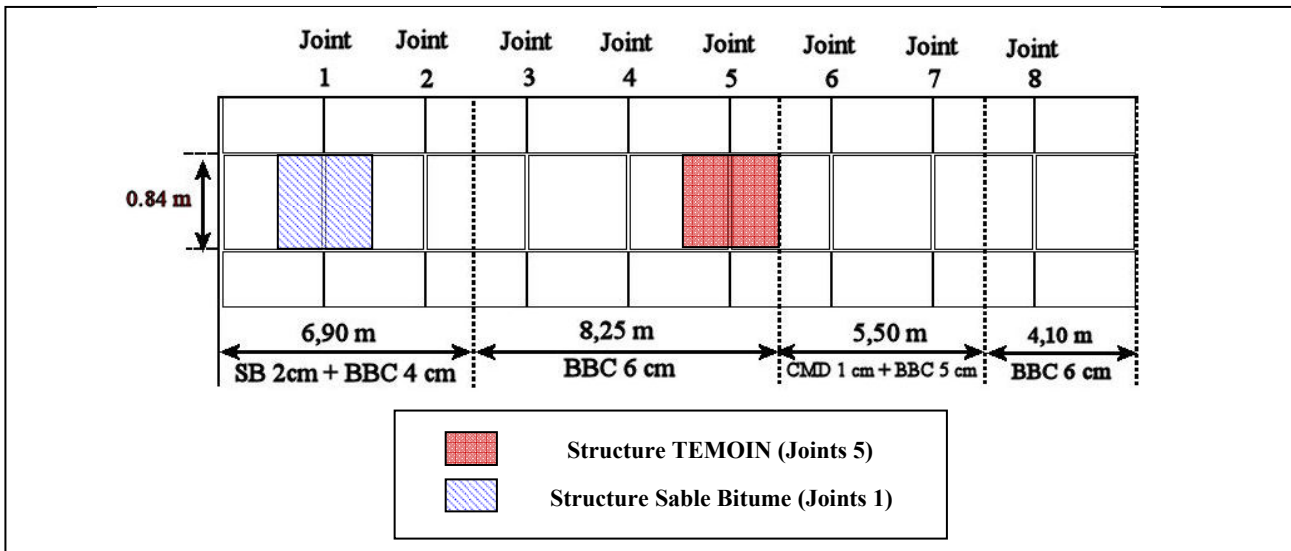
Disposition des structures par joint établie sur les dalles de la piste FABAC pour l’essai de fissuration
